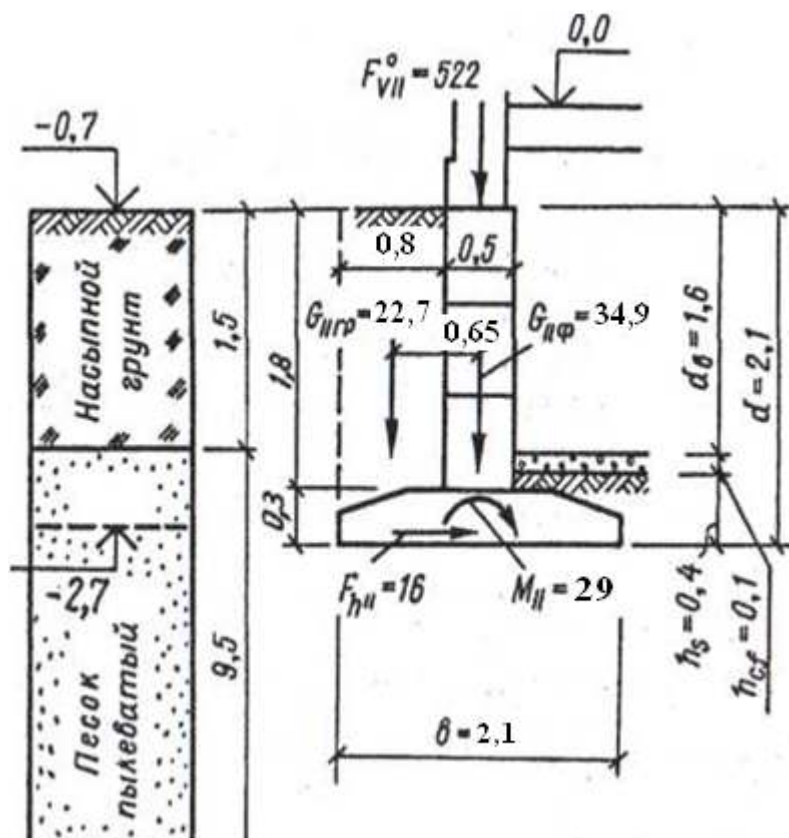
Расчётная схема поперечного сечения ленточного фундамента
